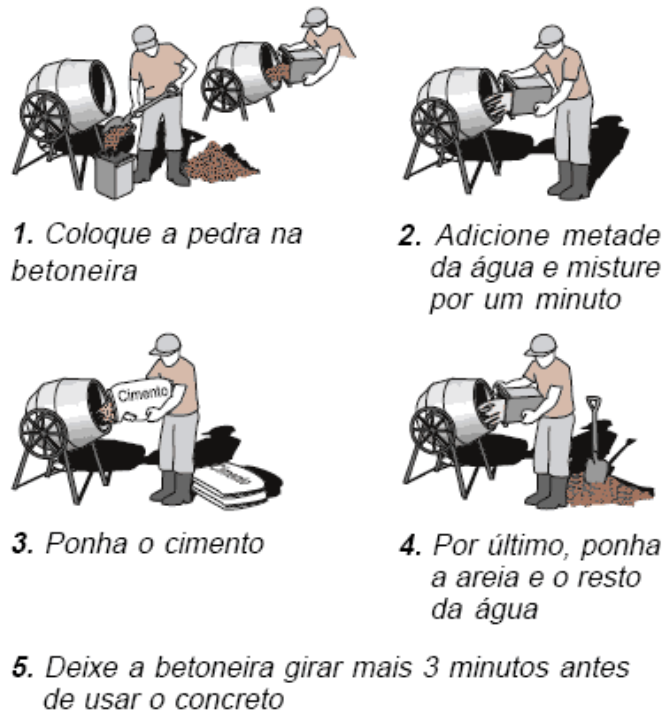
Misturando em Betoneira (Fonte: Faz Fácil).
